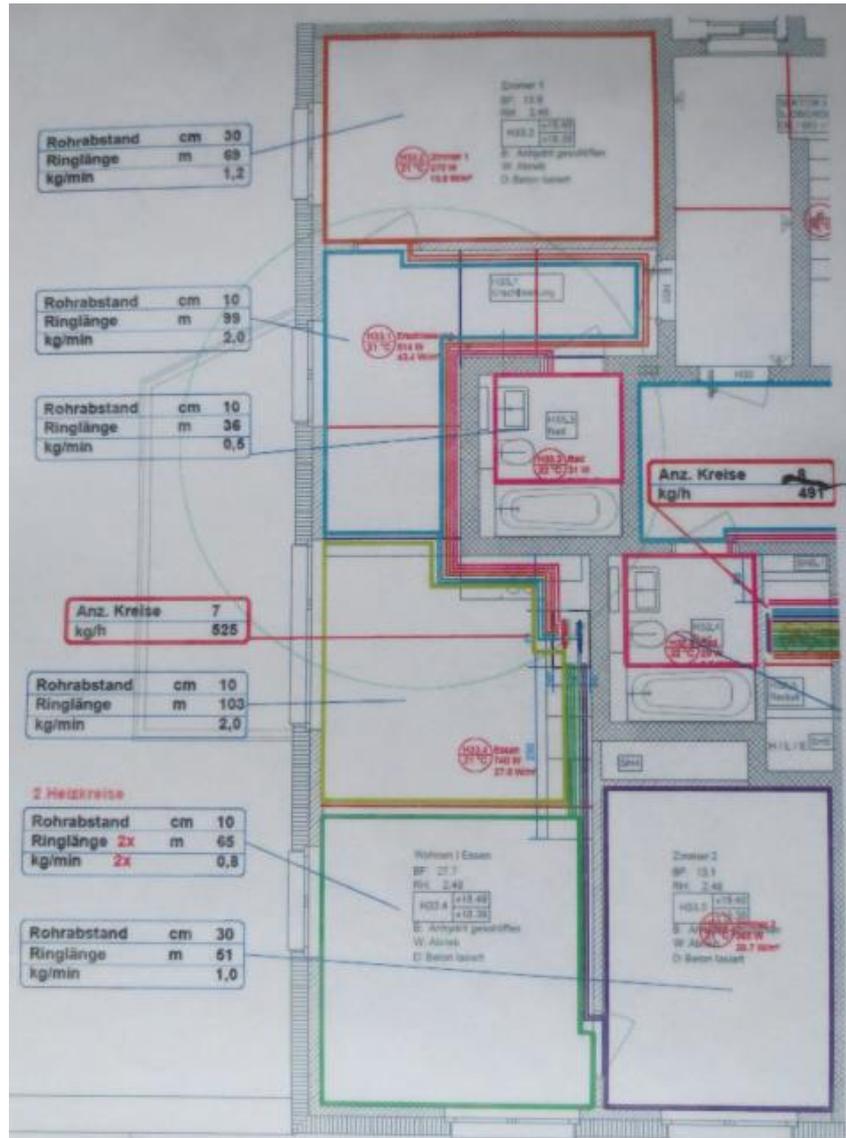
Grundriss Wohnung H33 mit Auslegung FBH
